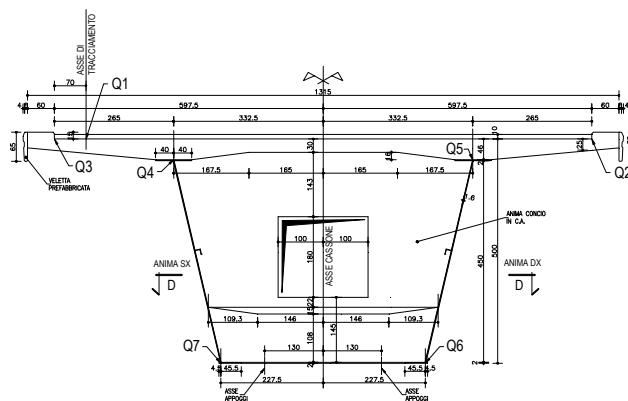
Sezione trasversale impalcato in asse pila – Progetto Esecutivo
